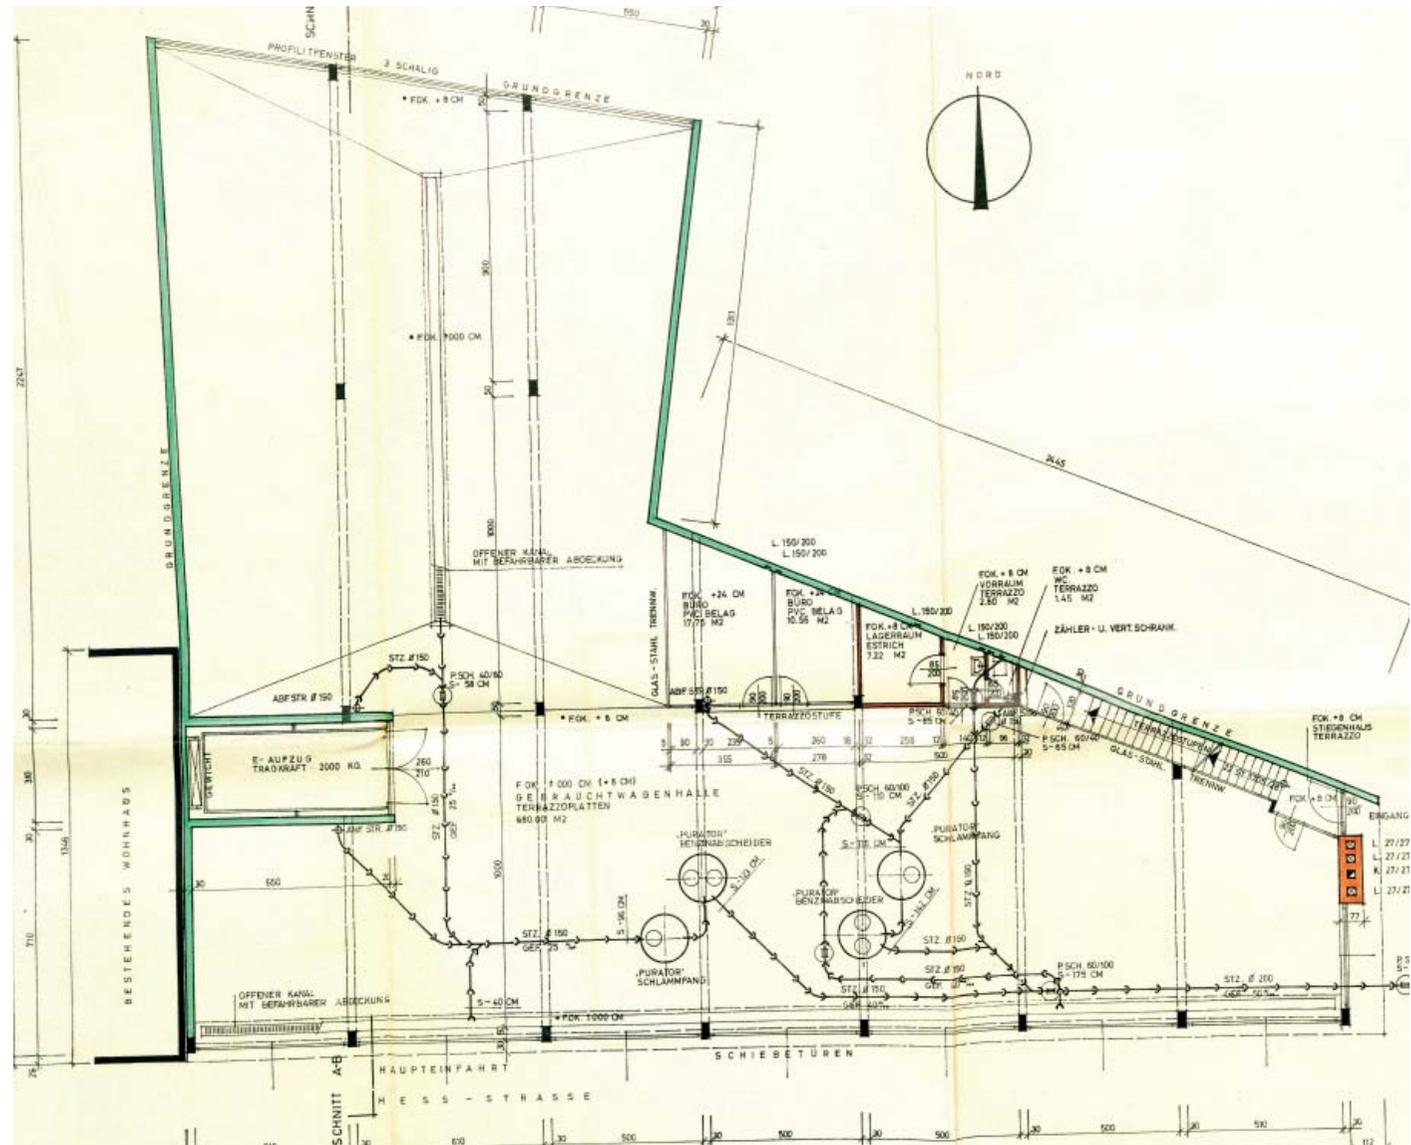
Auswechslungsplan, Erdgeschoss, 1969
